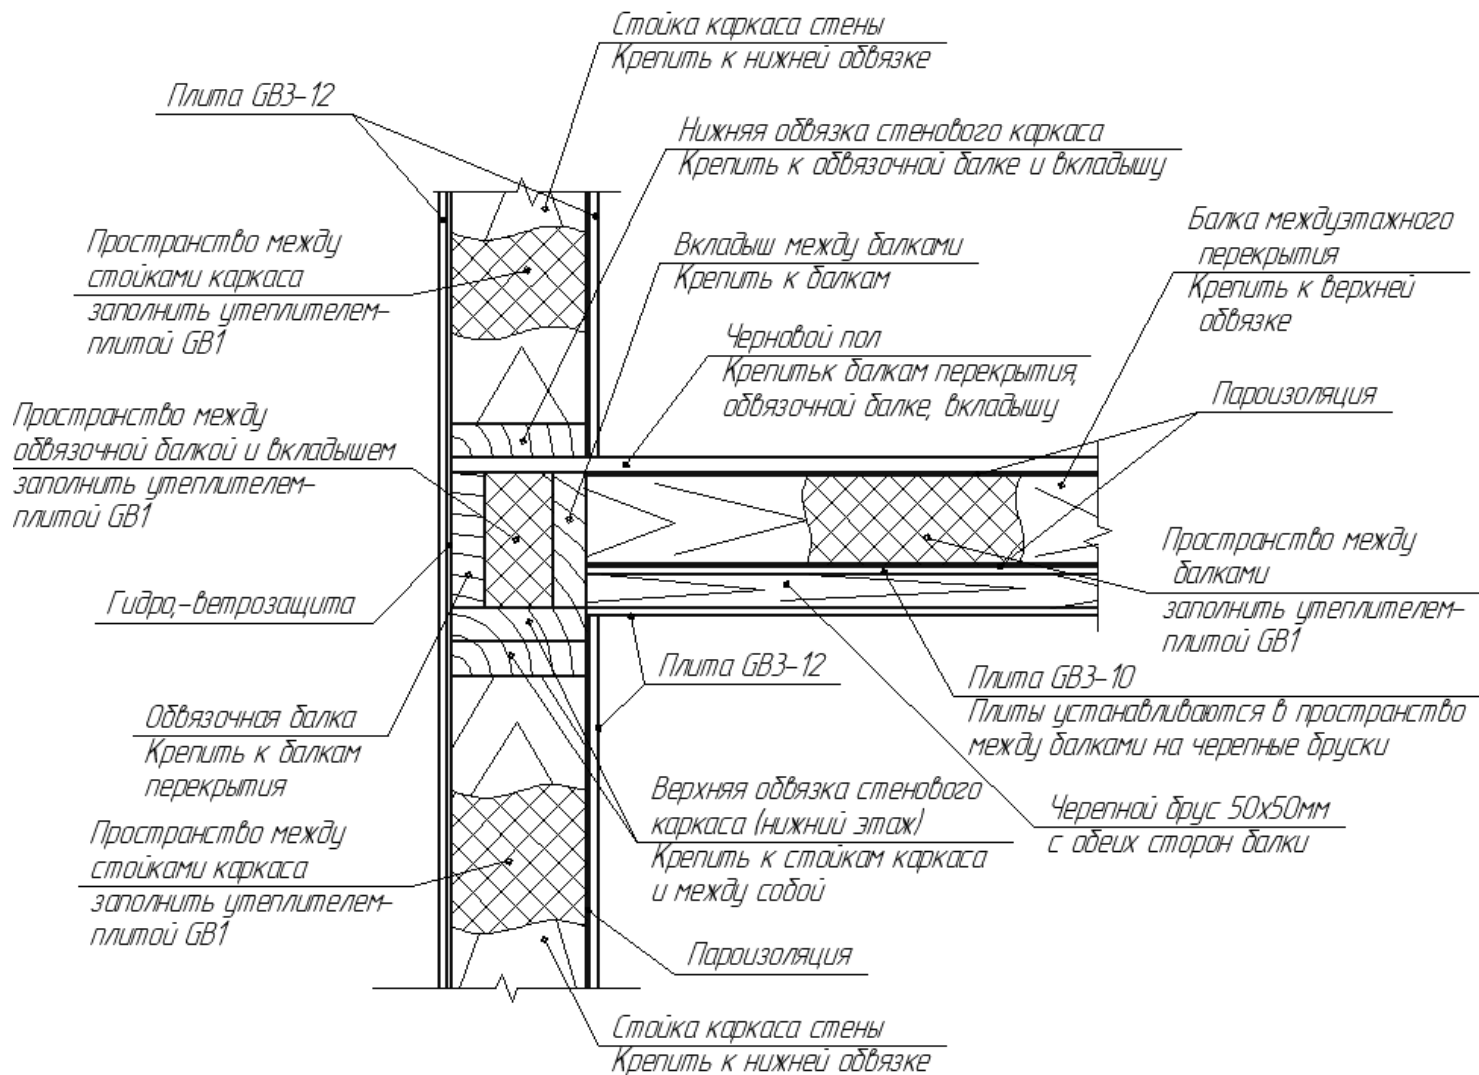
Опирание балок перекрытия на каркас наружной стены
